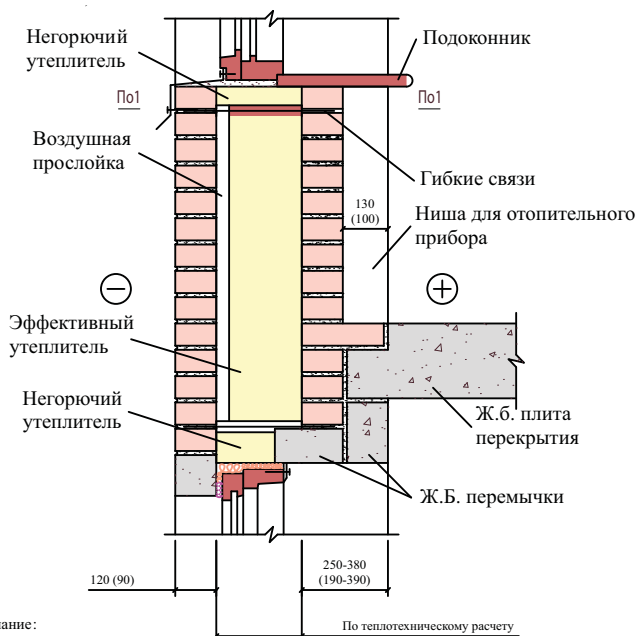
в. Междуконный пояс наружной стены для зданий высотой один-три этажа с самонесущим наружным слоем из кирпича, бетонных или керамических камней на гибких связях (тип ГС-1) с несущим внутренним слоем
